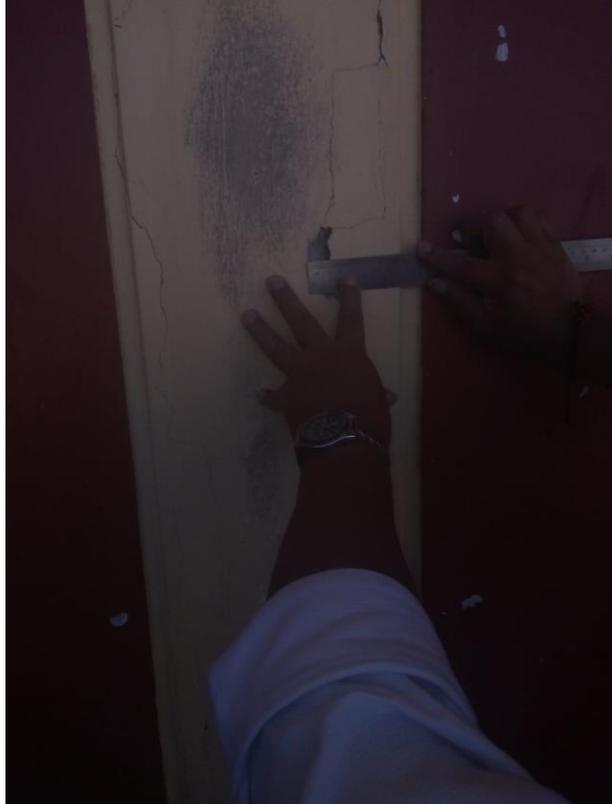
Grietas y fisuras en la columna del pabellón “B”
